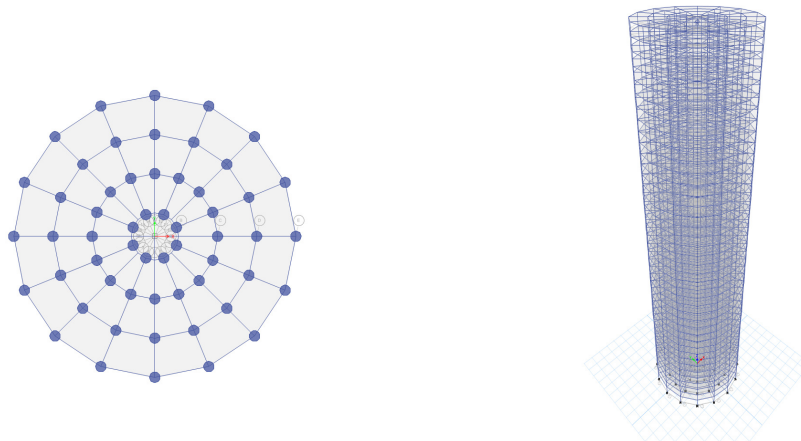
Structura cu cadre din b.a. avand forma circulara - plan si elevatie
